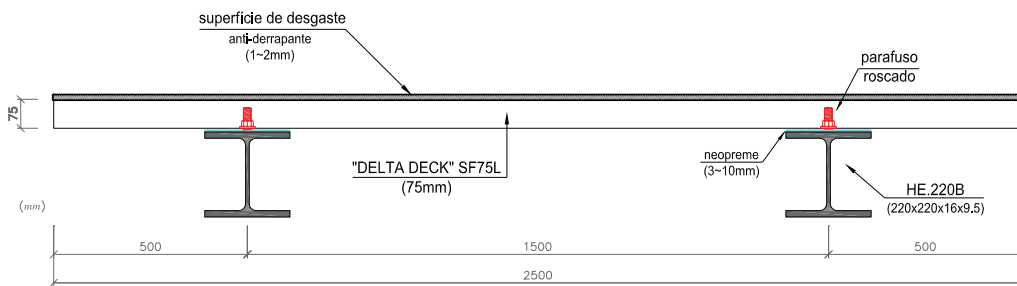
Secção mista do tabuleiro – painel GFRP / vigas em perfil HEB ($h_{total} \sim 300$ mm).
